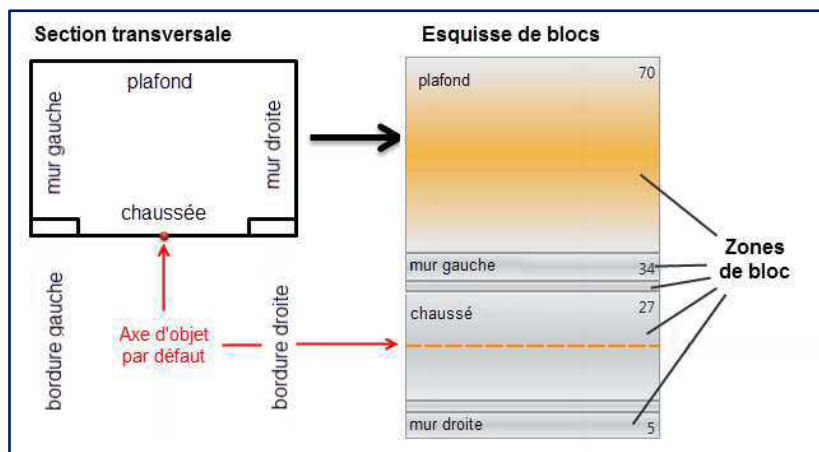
Section de tunnel et bloc de l'esquisse.
